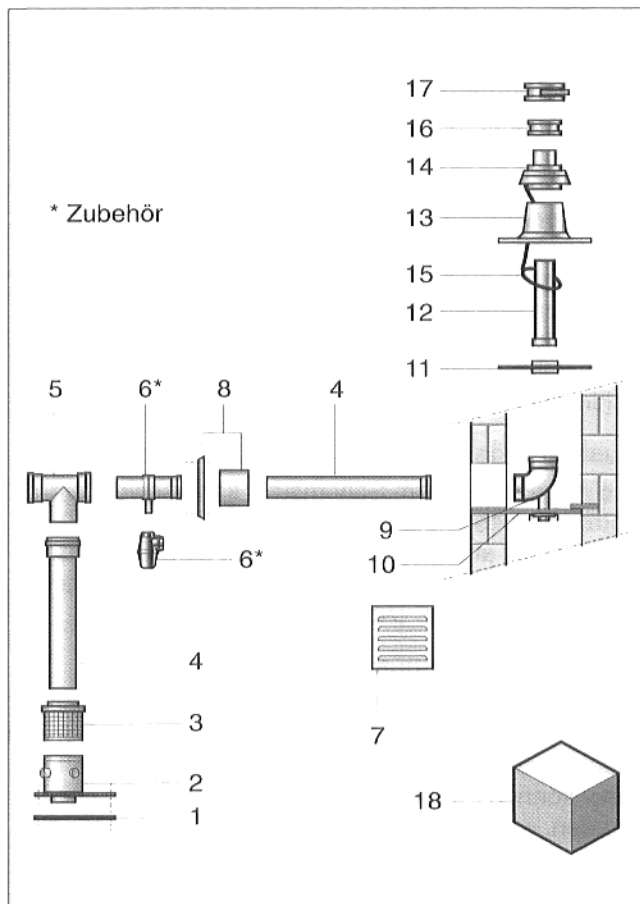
Lieferumfang Grundbausatz GA, Abgasführung mit Aluminium-Rohren
